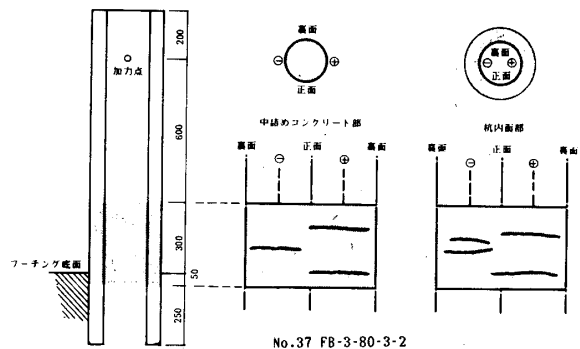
杭体および中詰めコンクリートのひび割れ図
